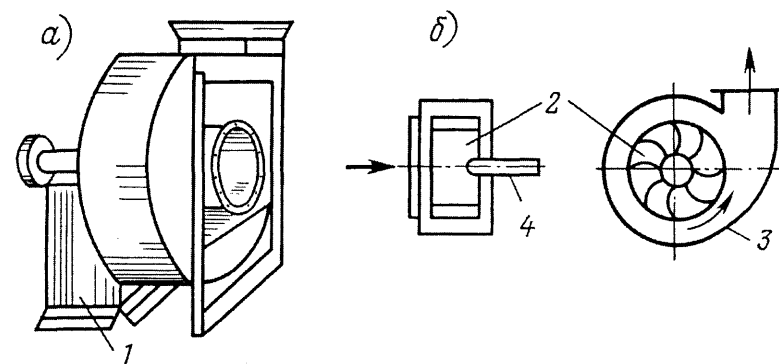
Общий вид (а) и схема устройства (б) центробежного вентилятора 1 — станина; 2 — рабочее колесо (ротор); 3 — спиральный корпус (кожух); 4 — вал
